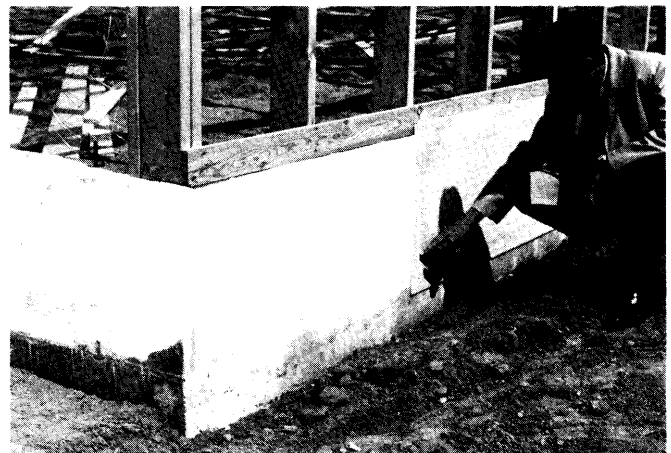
Isolation périphérique en mousse de polystyrène et panneaux d'amiante-ciment sur la face extérieure de la fondation de béton
